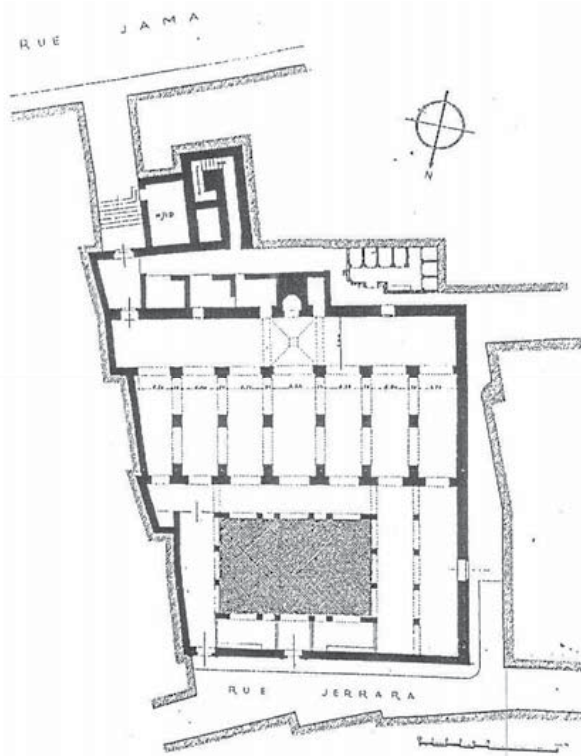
جامع قصبة مراكش، مسقط أفقي، عن:
